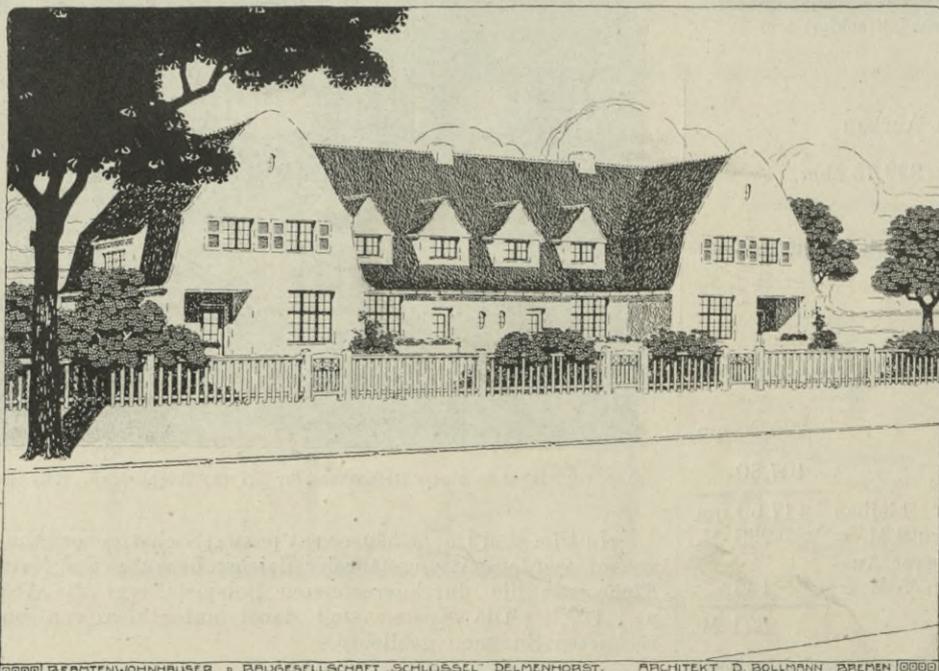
Beamtenhaus für Delmenhorst. Architekt D. Bollmann, Bremen
